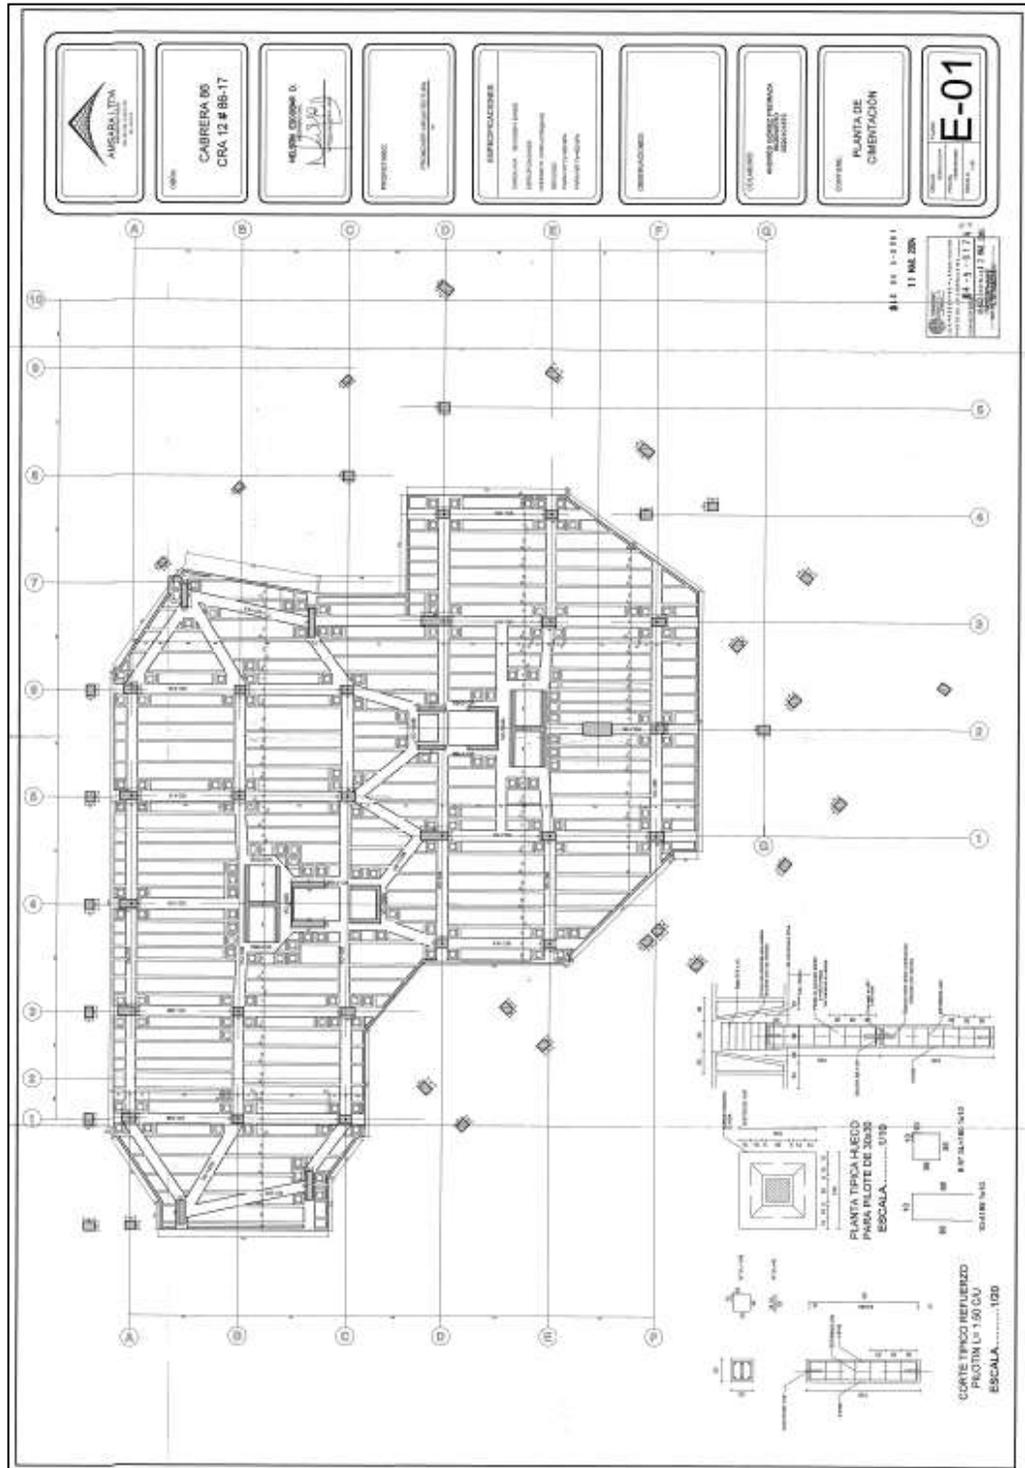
Planta de cimentación Ed. Proyecto Parque 86
